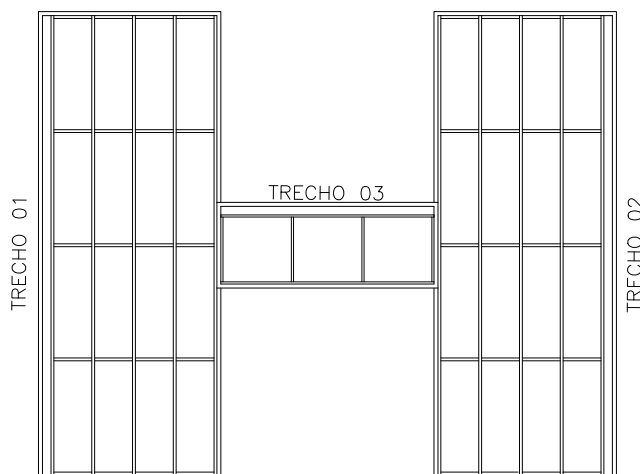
Concepção Estrutural - Corte Transversal da Estrutura para alocação das caixas d'água.
